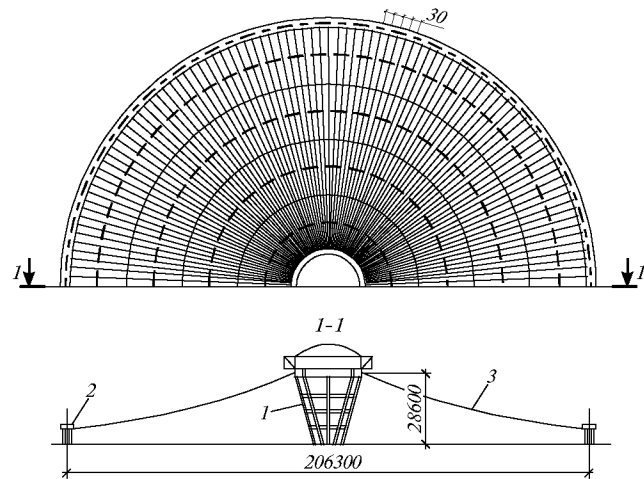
Конструктивная схема покрытия стоянки для грузовых автомобилей в Усть-Илимске: 1 – железобетонные колонны; 2 – железобетонный опорный контур; 3 – мембранная шатровая оболочка
